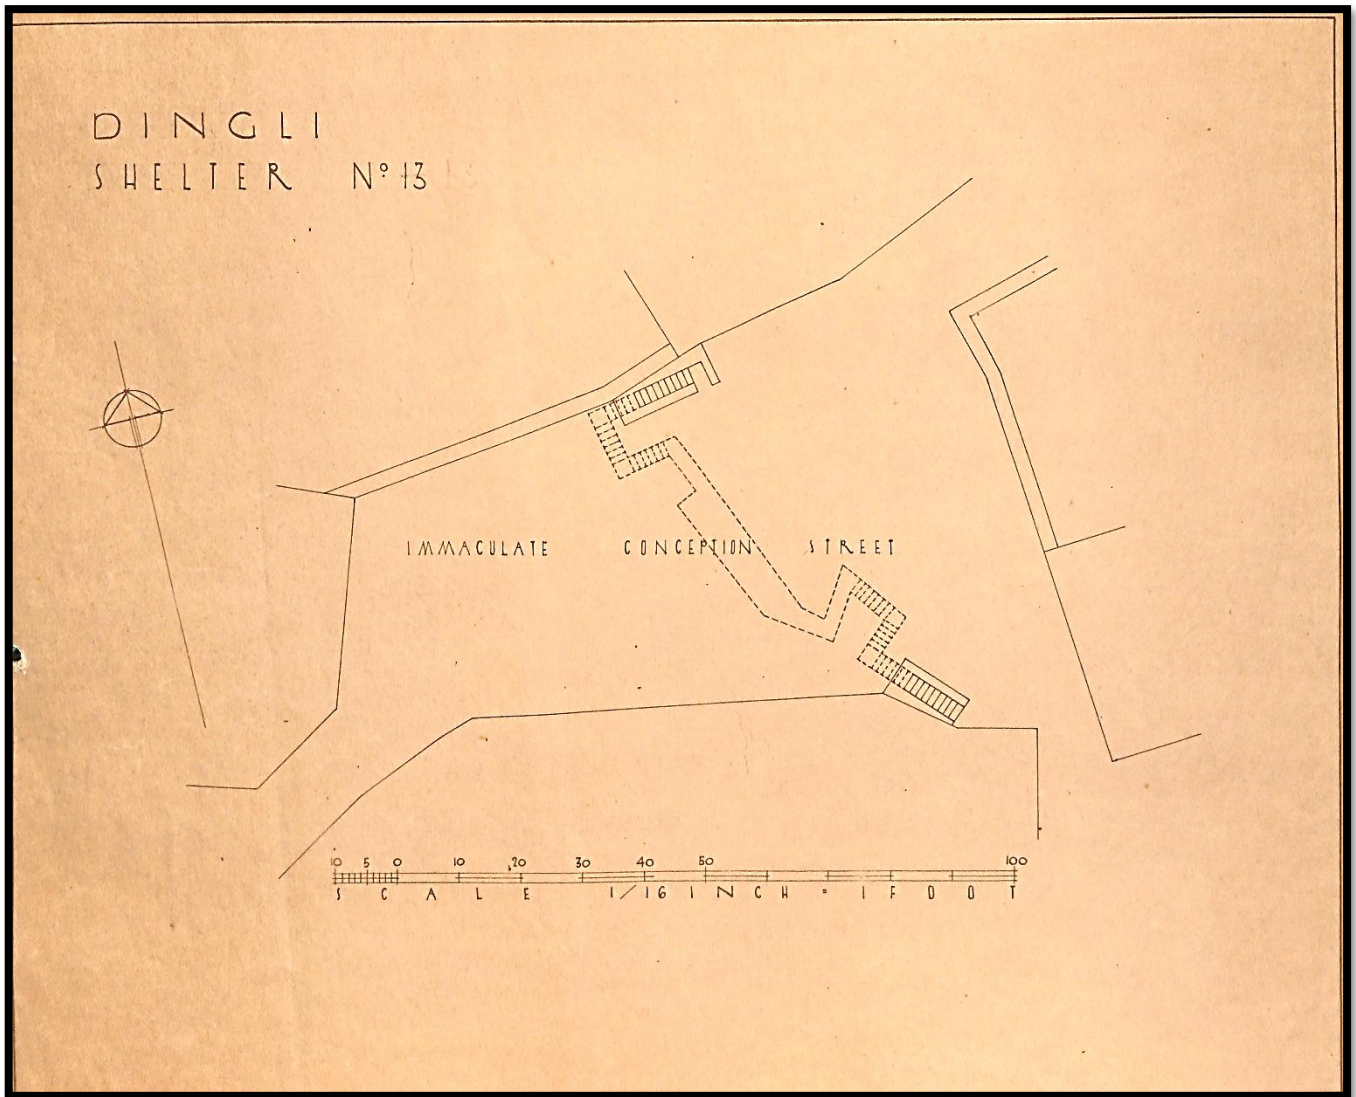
Planta do Abrigo nº 13 "Immaculate Conception Street"
